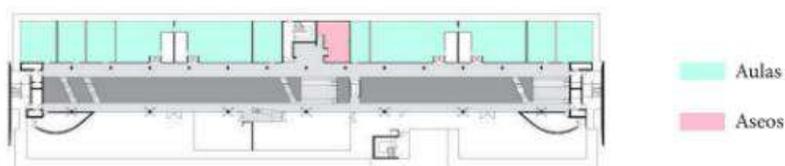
Planta de 3º y 4º piso colegio Montessori College Oost
